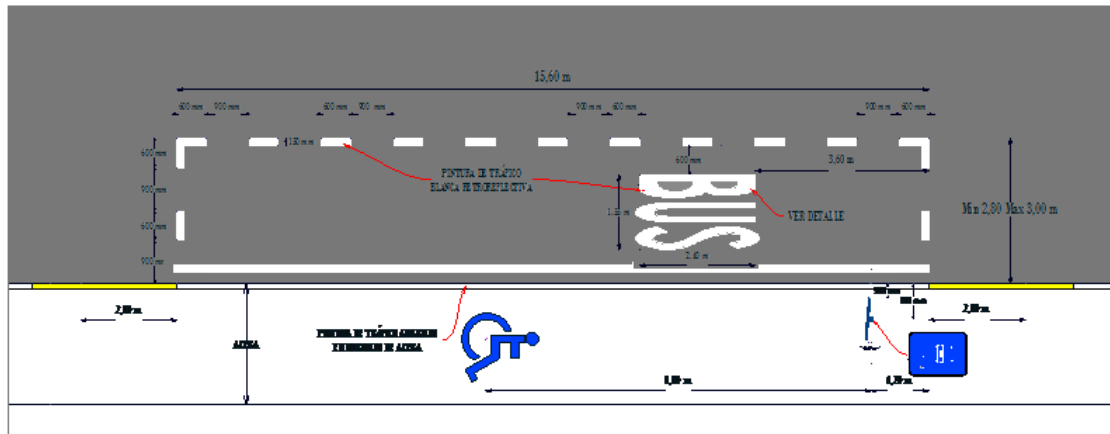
Carril SOLO BUS (dimensiones en mm)
